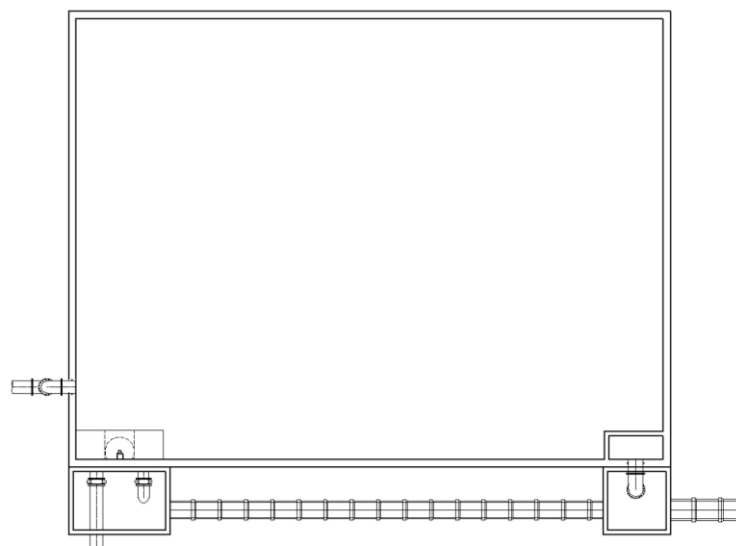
Esquema em planta do retangular enterrado ou semi-enterrado (Reservatório Tipo 3)
